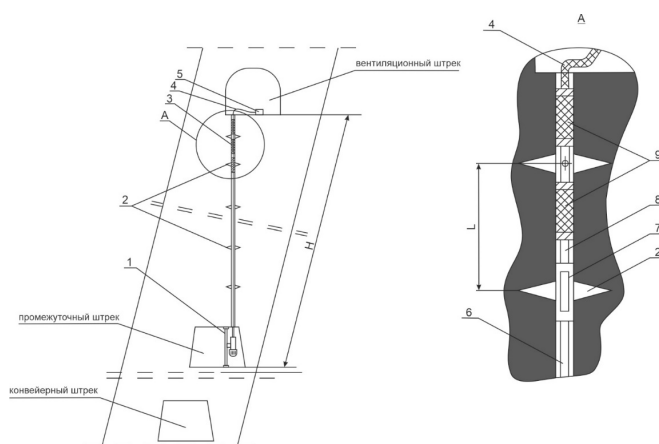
Схема проведения поинтервального гидроразрыва. 1 – буровой станок; 2 – инициирующие щели; 3 – пакер; 4 – гибкий трубопровод; 5 – насосная установка; 6 – жесткий трубопровод; 7 – щелеобразователь; 8 – соединительная муфта (вертлюг); 9 – уплотнительные элементы
